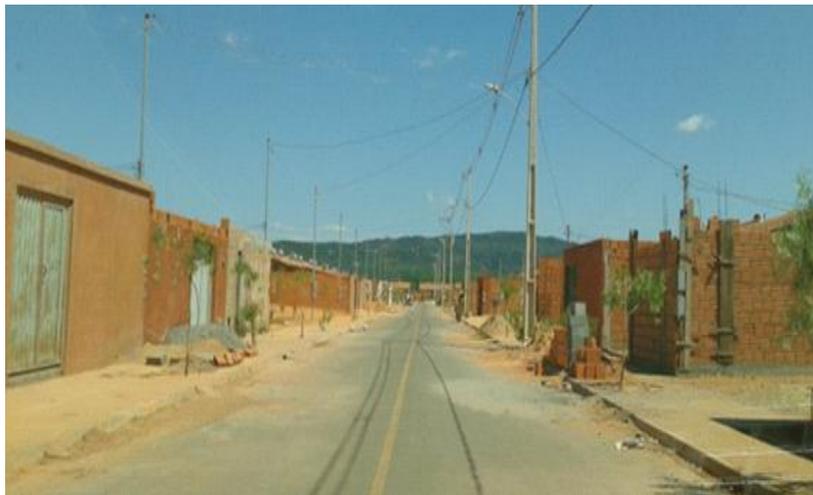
Muro em construção no Residencial Vitória I. -Fonte: foto deste autor.
